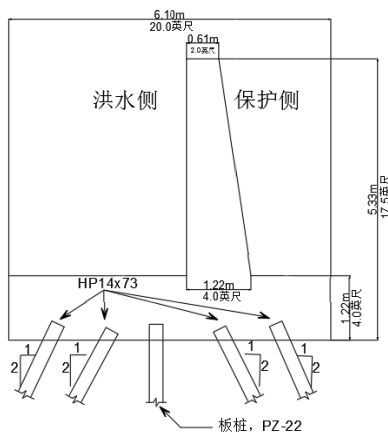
LPV111 钢筋混凝土 T 形墙典型截面
